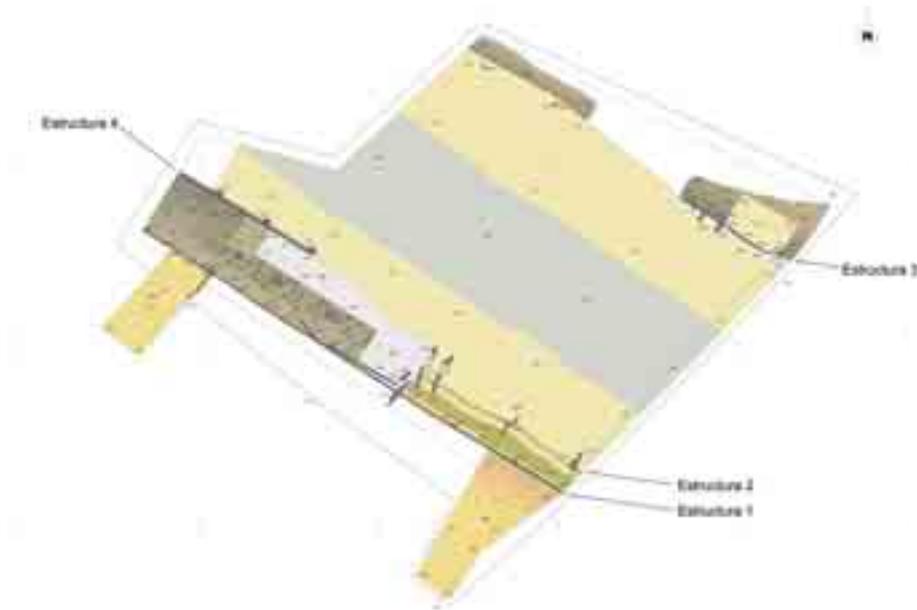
Planta general. Intervención en el estanque de Tormentas.
